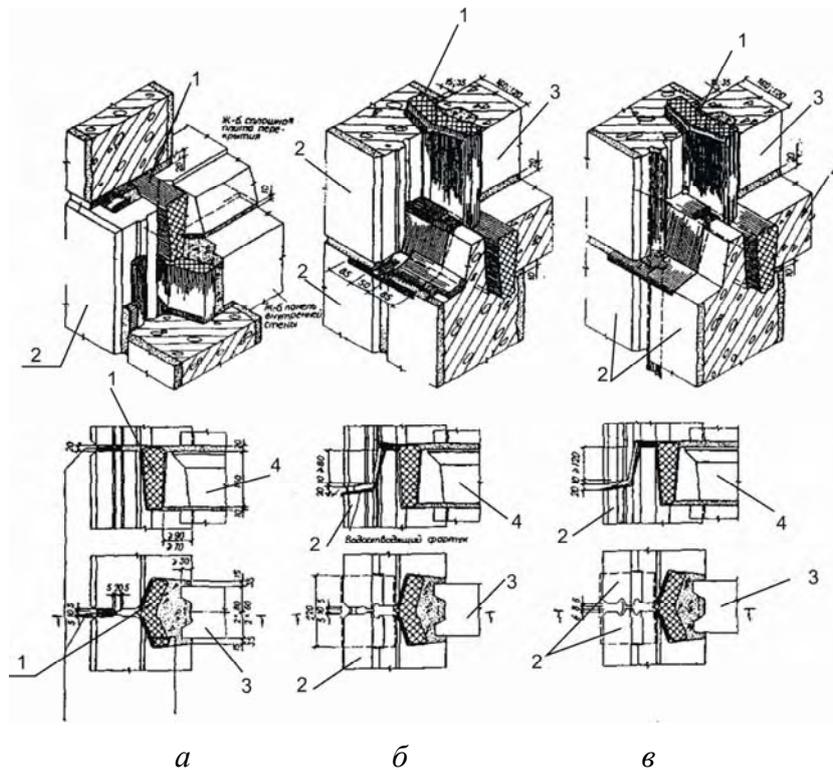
Виды стыков панельных стен: *а* — закрытый; *б* — дренированный; *в* — открытый: 1 — вертикальный термовкладыш; 2 — наружная стеновая панель; 3 — внутренняя стеновая панель; 4 — междуэтажное перекрытие
